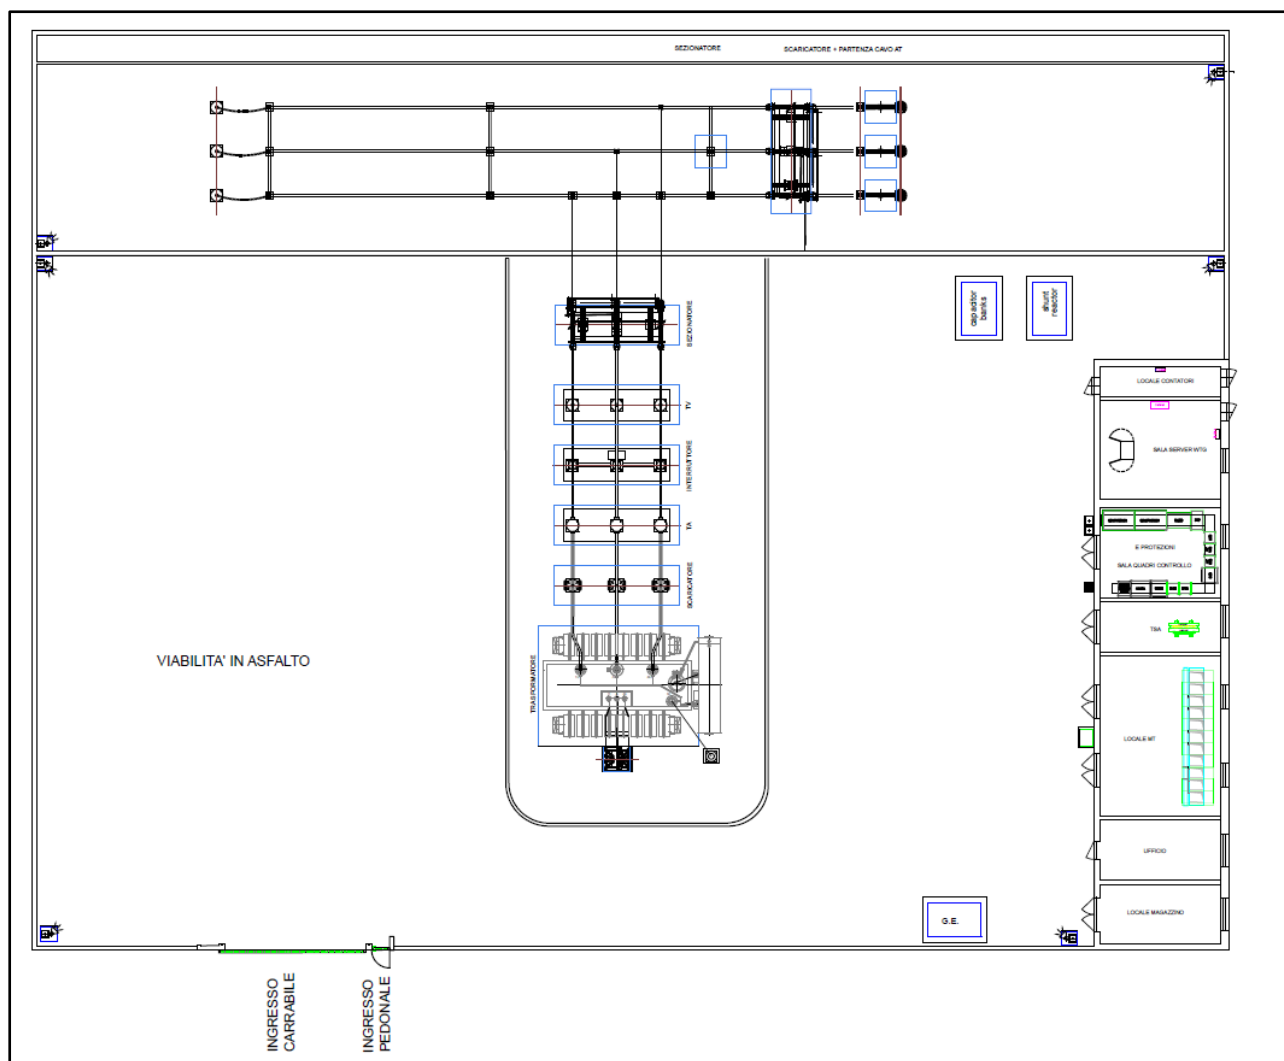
Planimetria elettromeccanica della Stazione Elettrica Utente 150/33 kV
